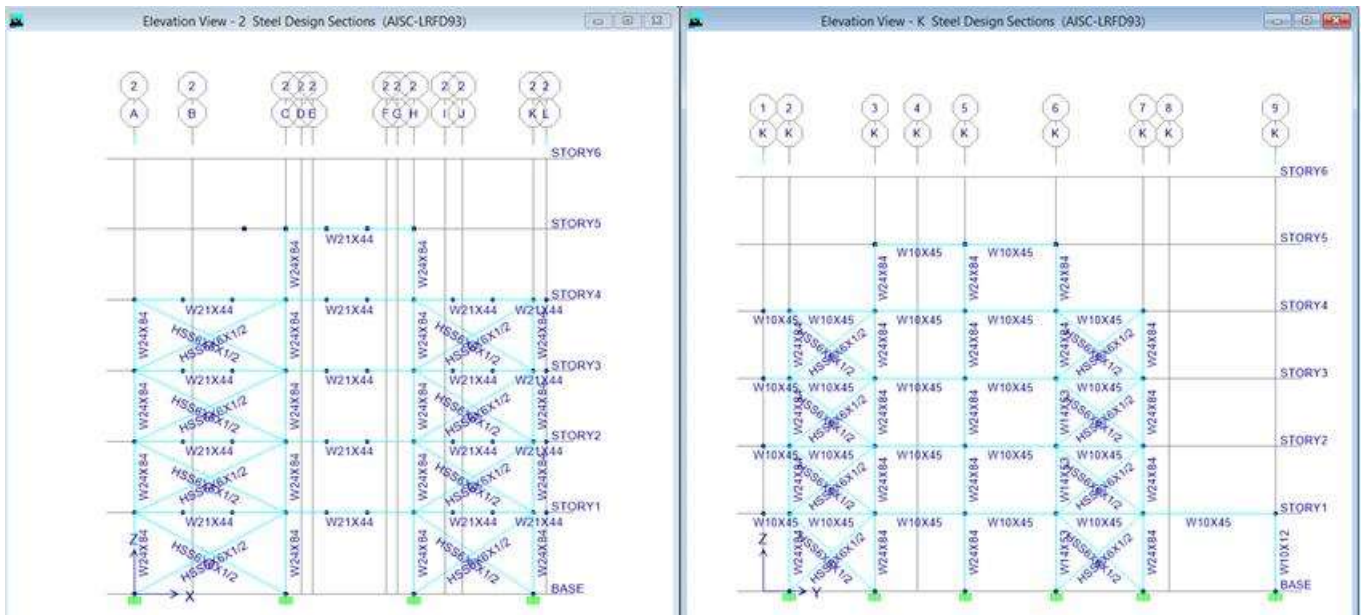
vistas laterales del edificio diseñado de acero estructural con su predimensionamiento
